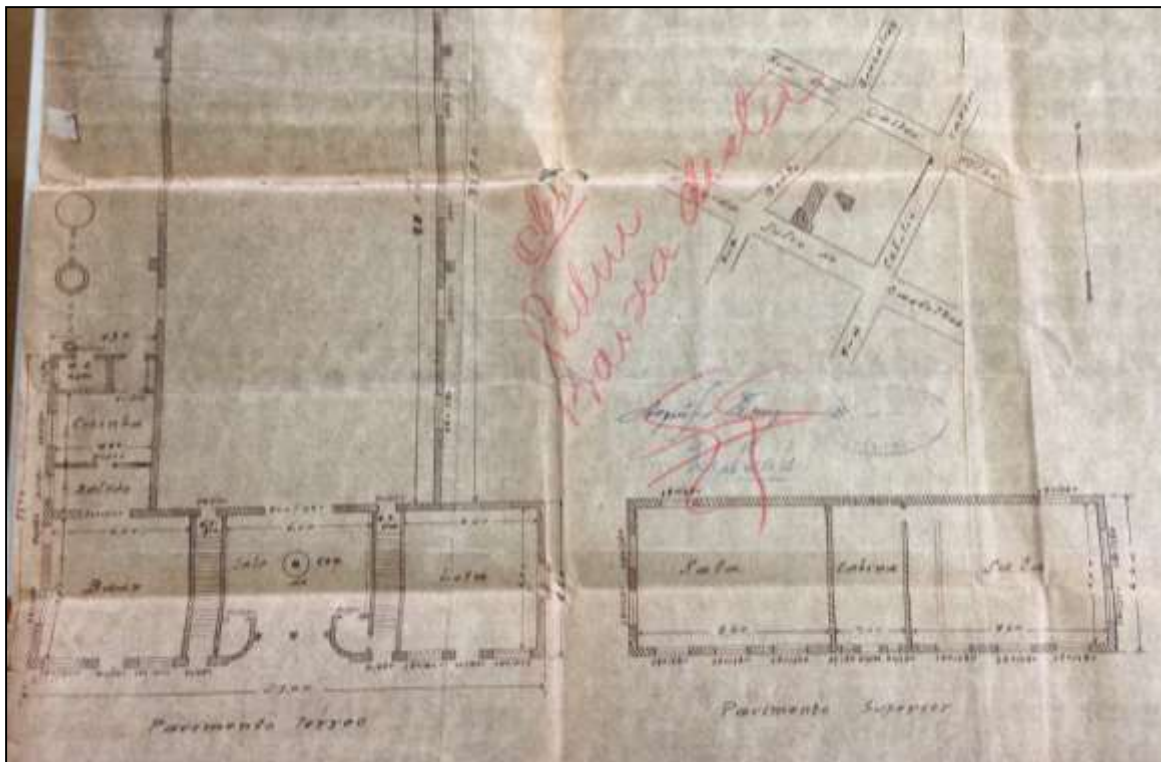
Corte dos pavimentos térreo e superior com detalhe para o terreno na quadra 43.
